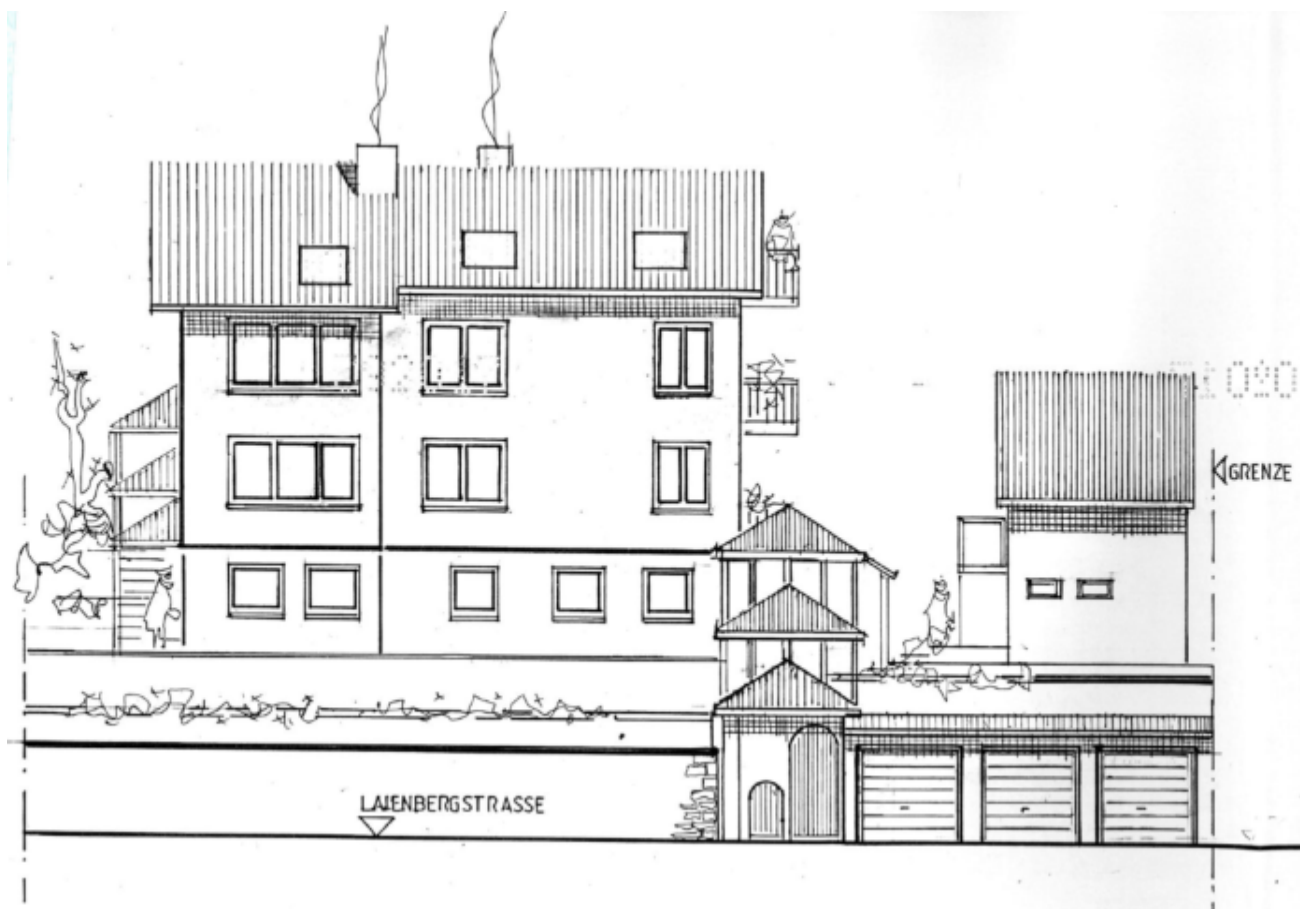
Westansicht; Quelle: Bauakte; Dachgeschossausbau Nachgesuch; 2017
